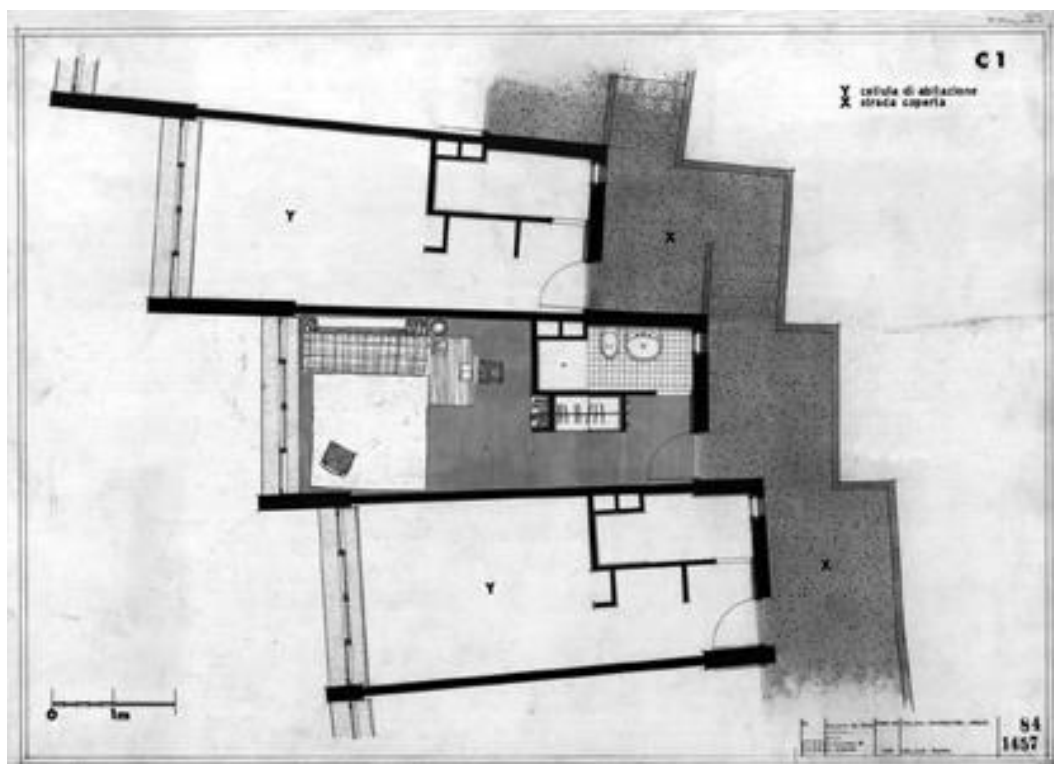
Particolare disposizione alloggi - Fonte: www.architettura.it
